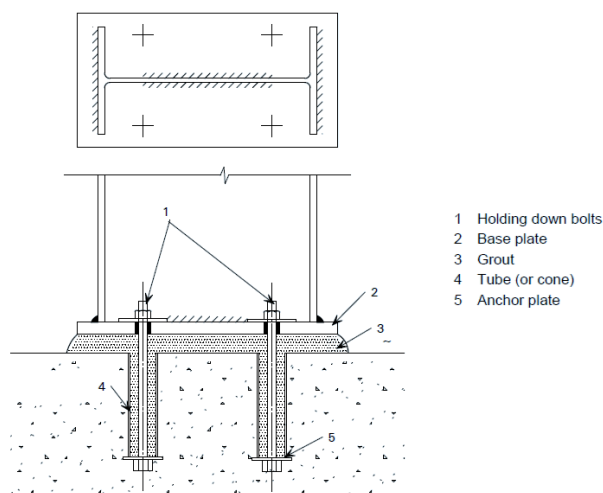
Ligação pilar-fundação (SECHALO, *Steel buildings in europe - single-storey steel buildings - Part2: Concept design, 2012*)
